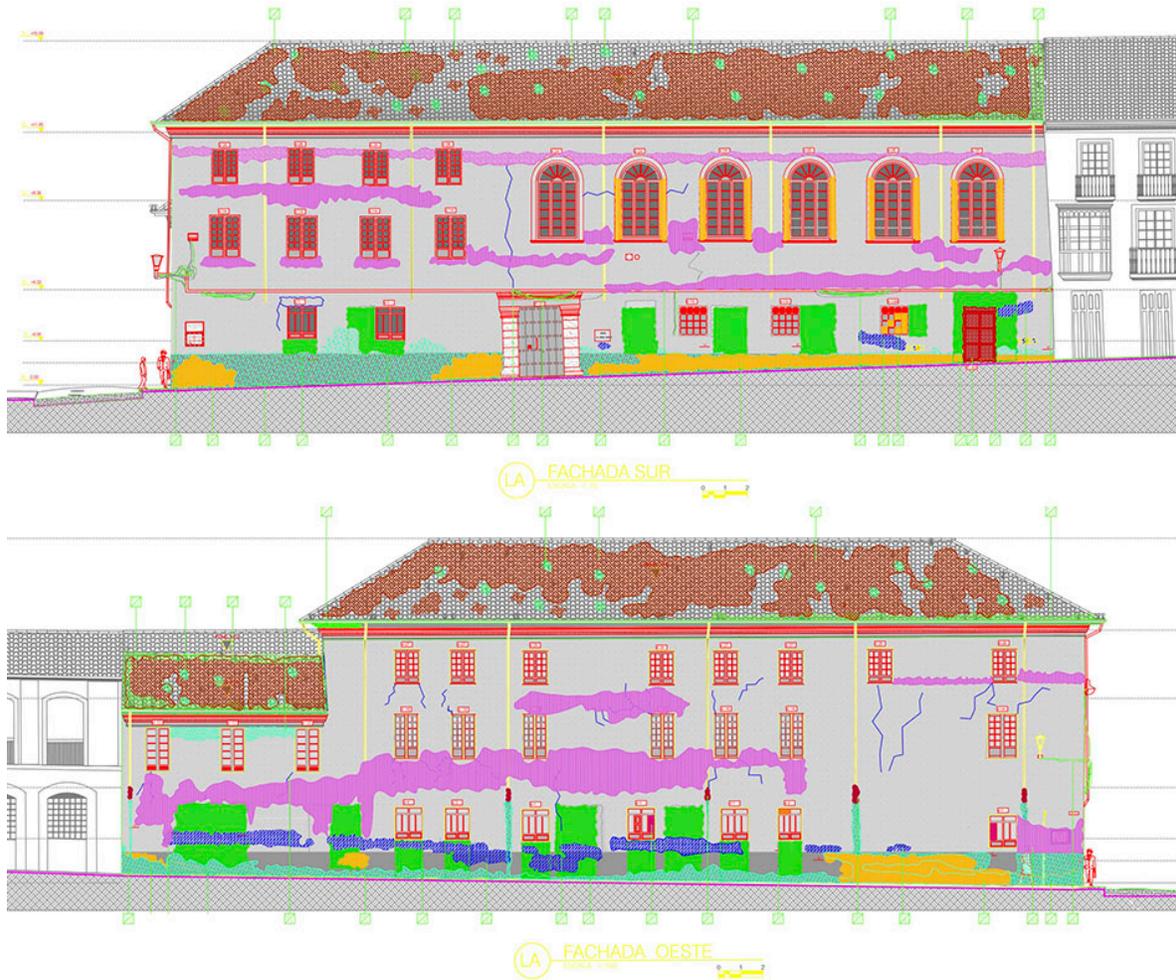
Plano Patológico Fachadas. Realizado CRC-MGC.
